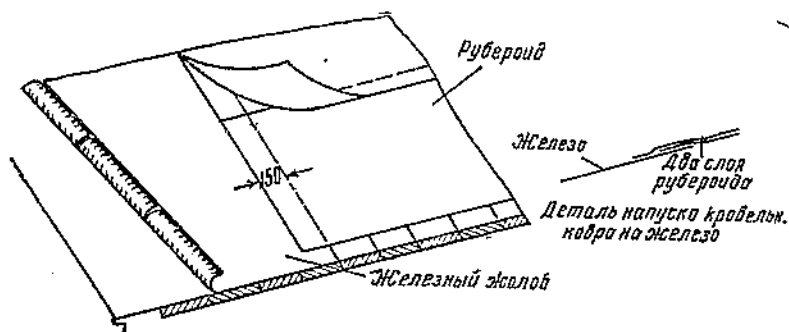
Открытие свеса крыши и устройство настенных желобов из кровельного железа.
